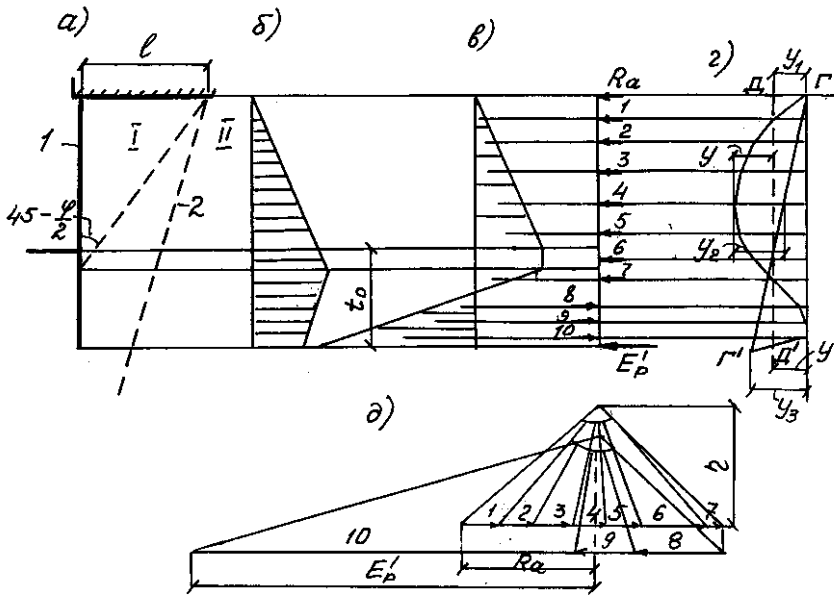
Схема к расчету передней шпунтовой стенки свайной набережной:
